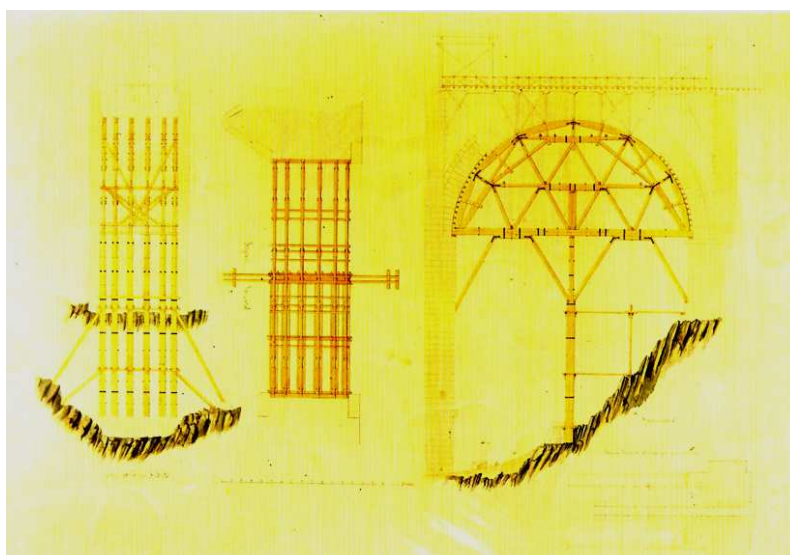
Cimbra proyectada por Alejandro Millán para la reconstrucción del arco
